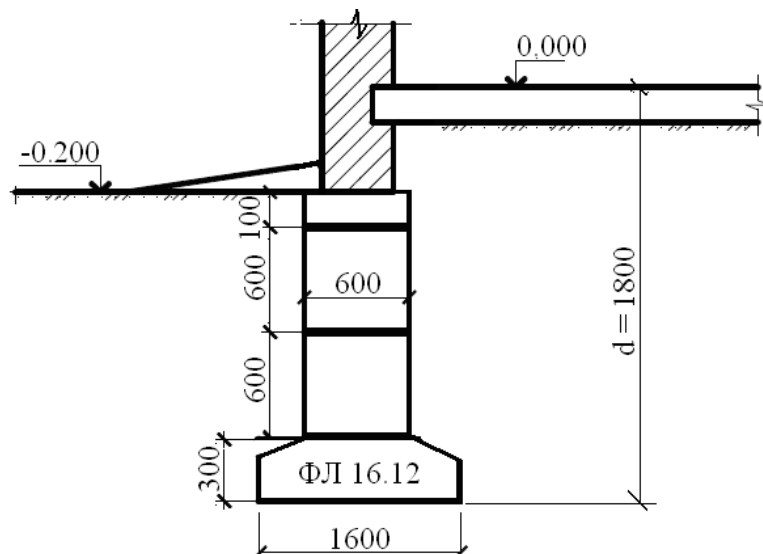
Схема к определению размеров подошвы ленточного фундамента
